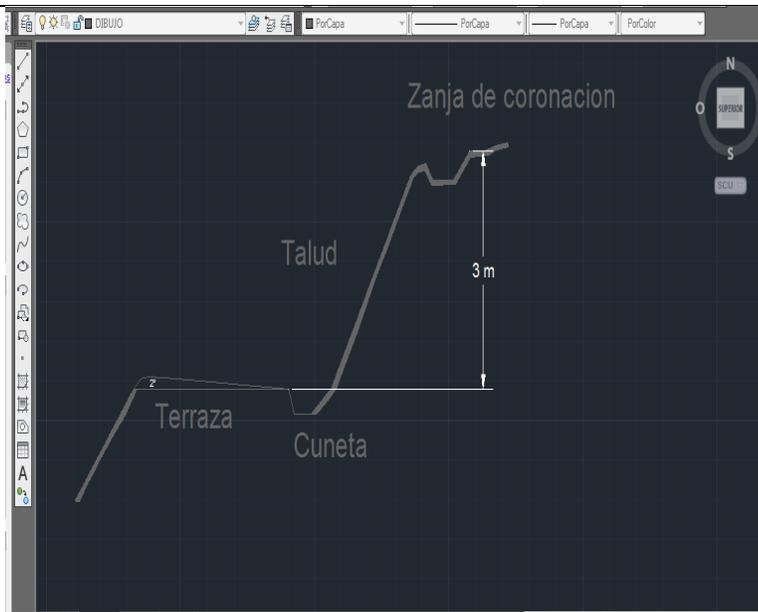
Drenaje en terrazas. (Fuente; Autocad y El Autor)
